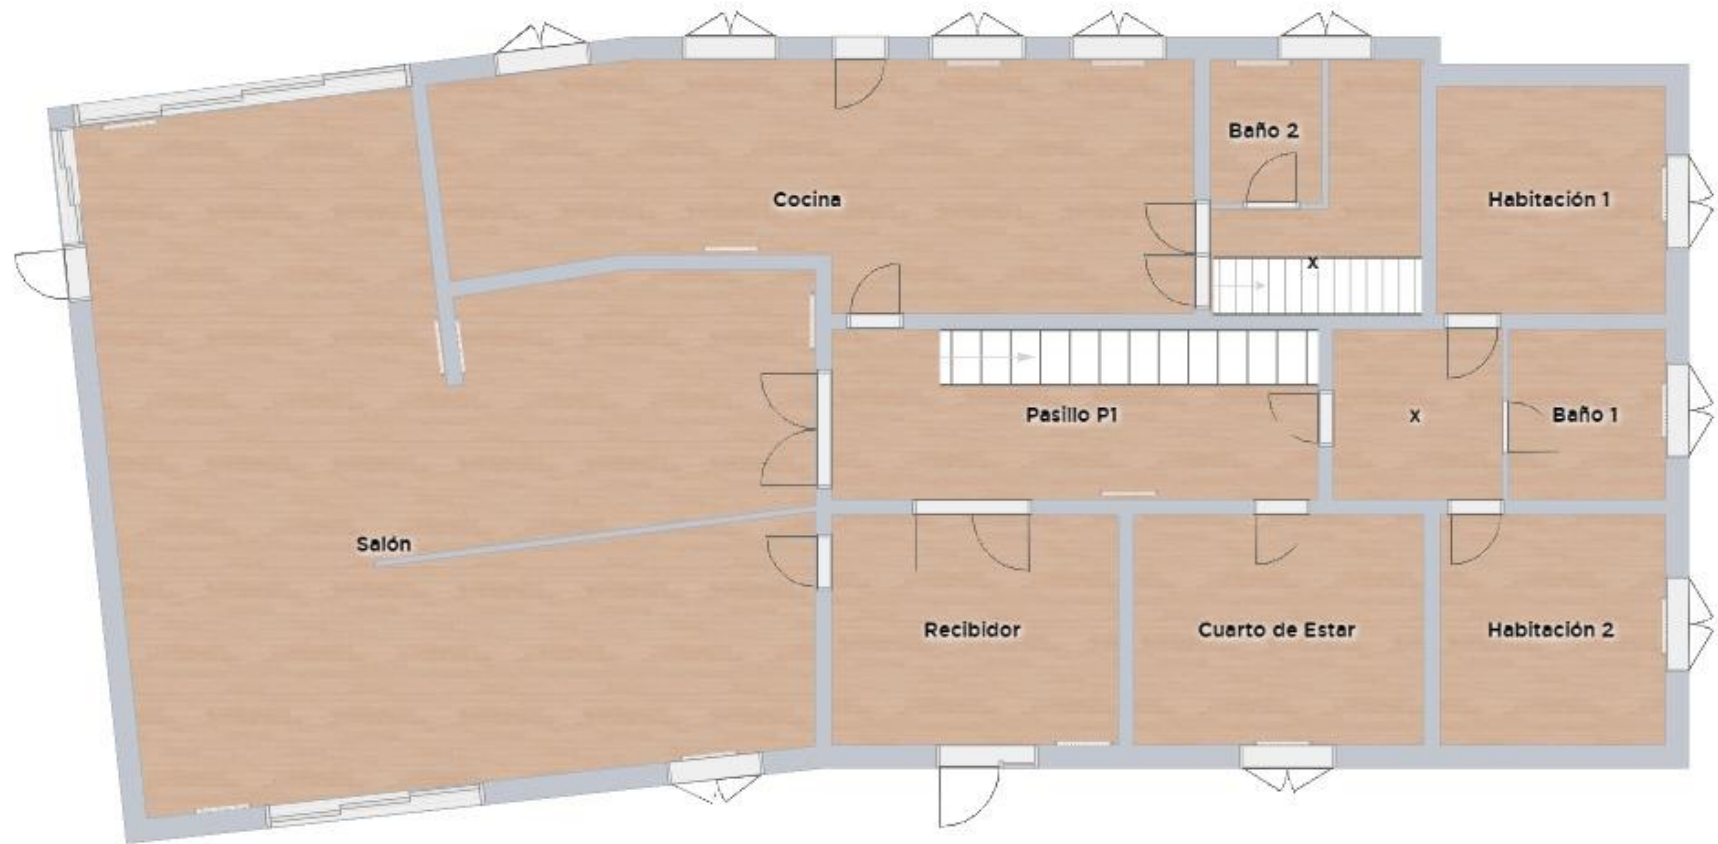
Imagen del plano original de la vista en planta del terreno. (Fuente: Planos originales realizados por D. Antonio Miranda Sánchez)
